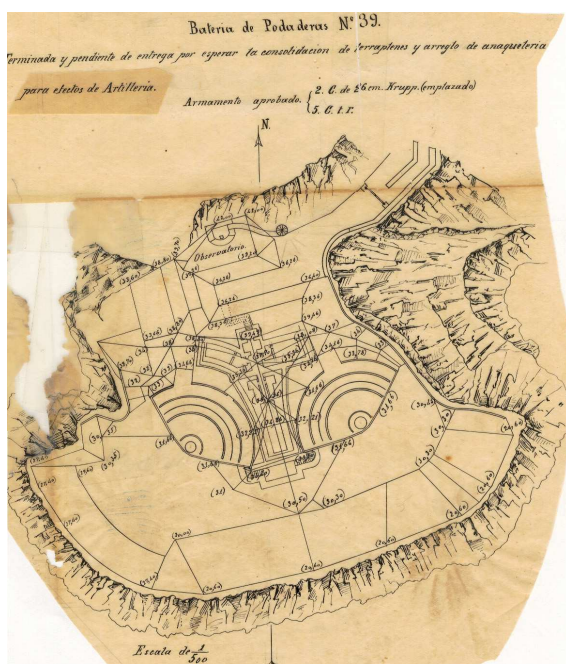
(izq.). Bateria de la Podadera (Plano correspondiente al artillado de 1895, con dos barbetas para dos piezas Krupp de 26/35 (Fuente: Plan Director. PD).
